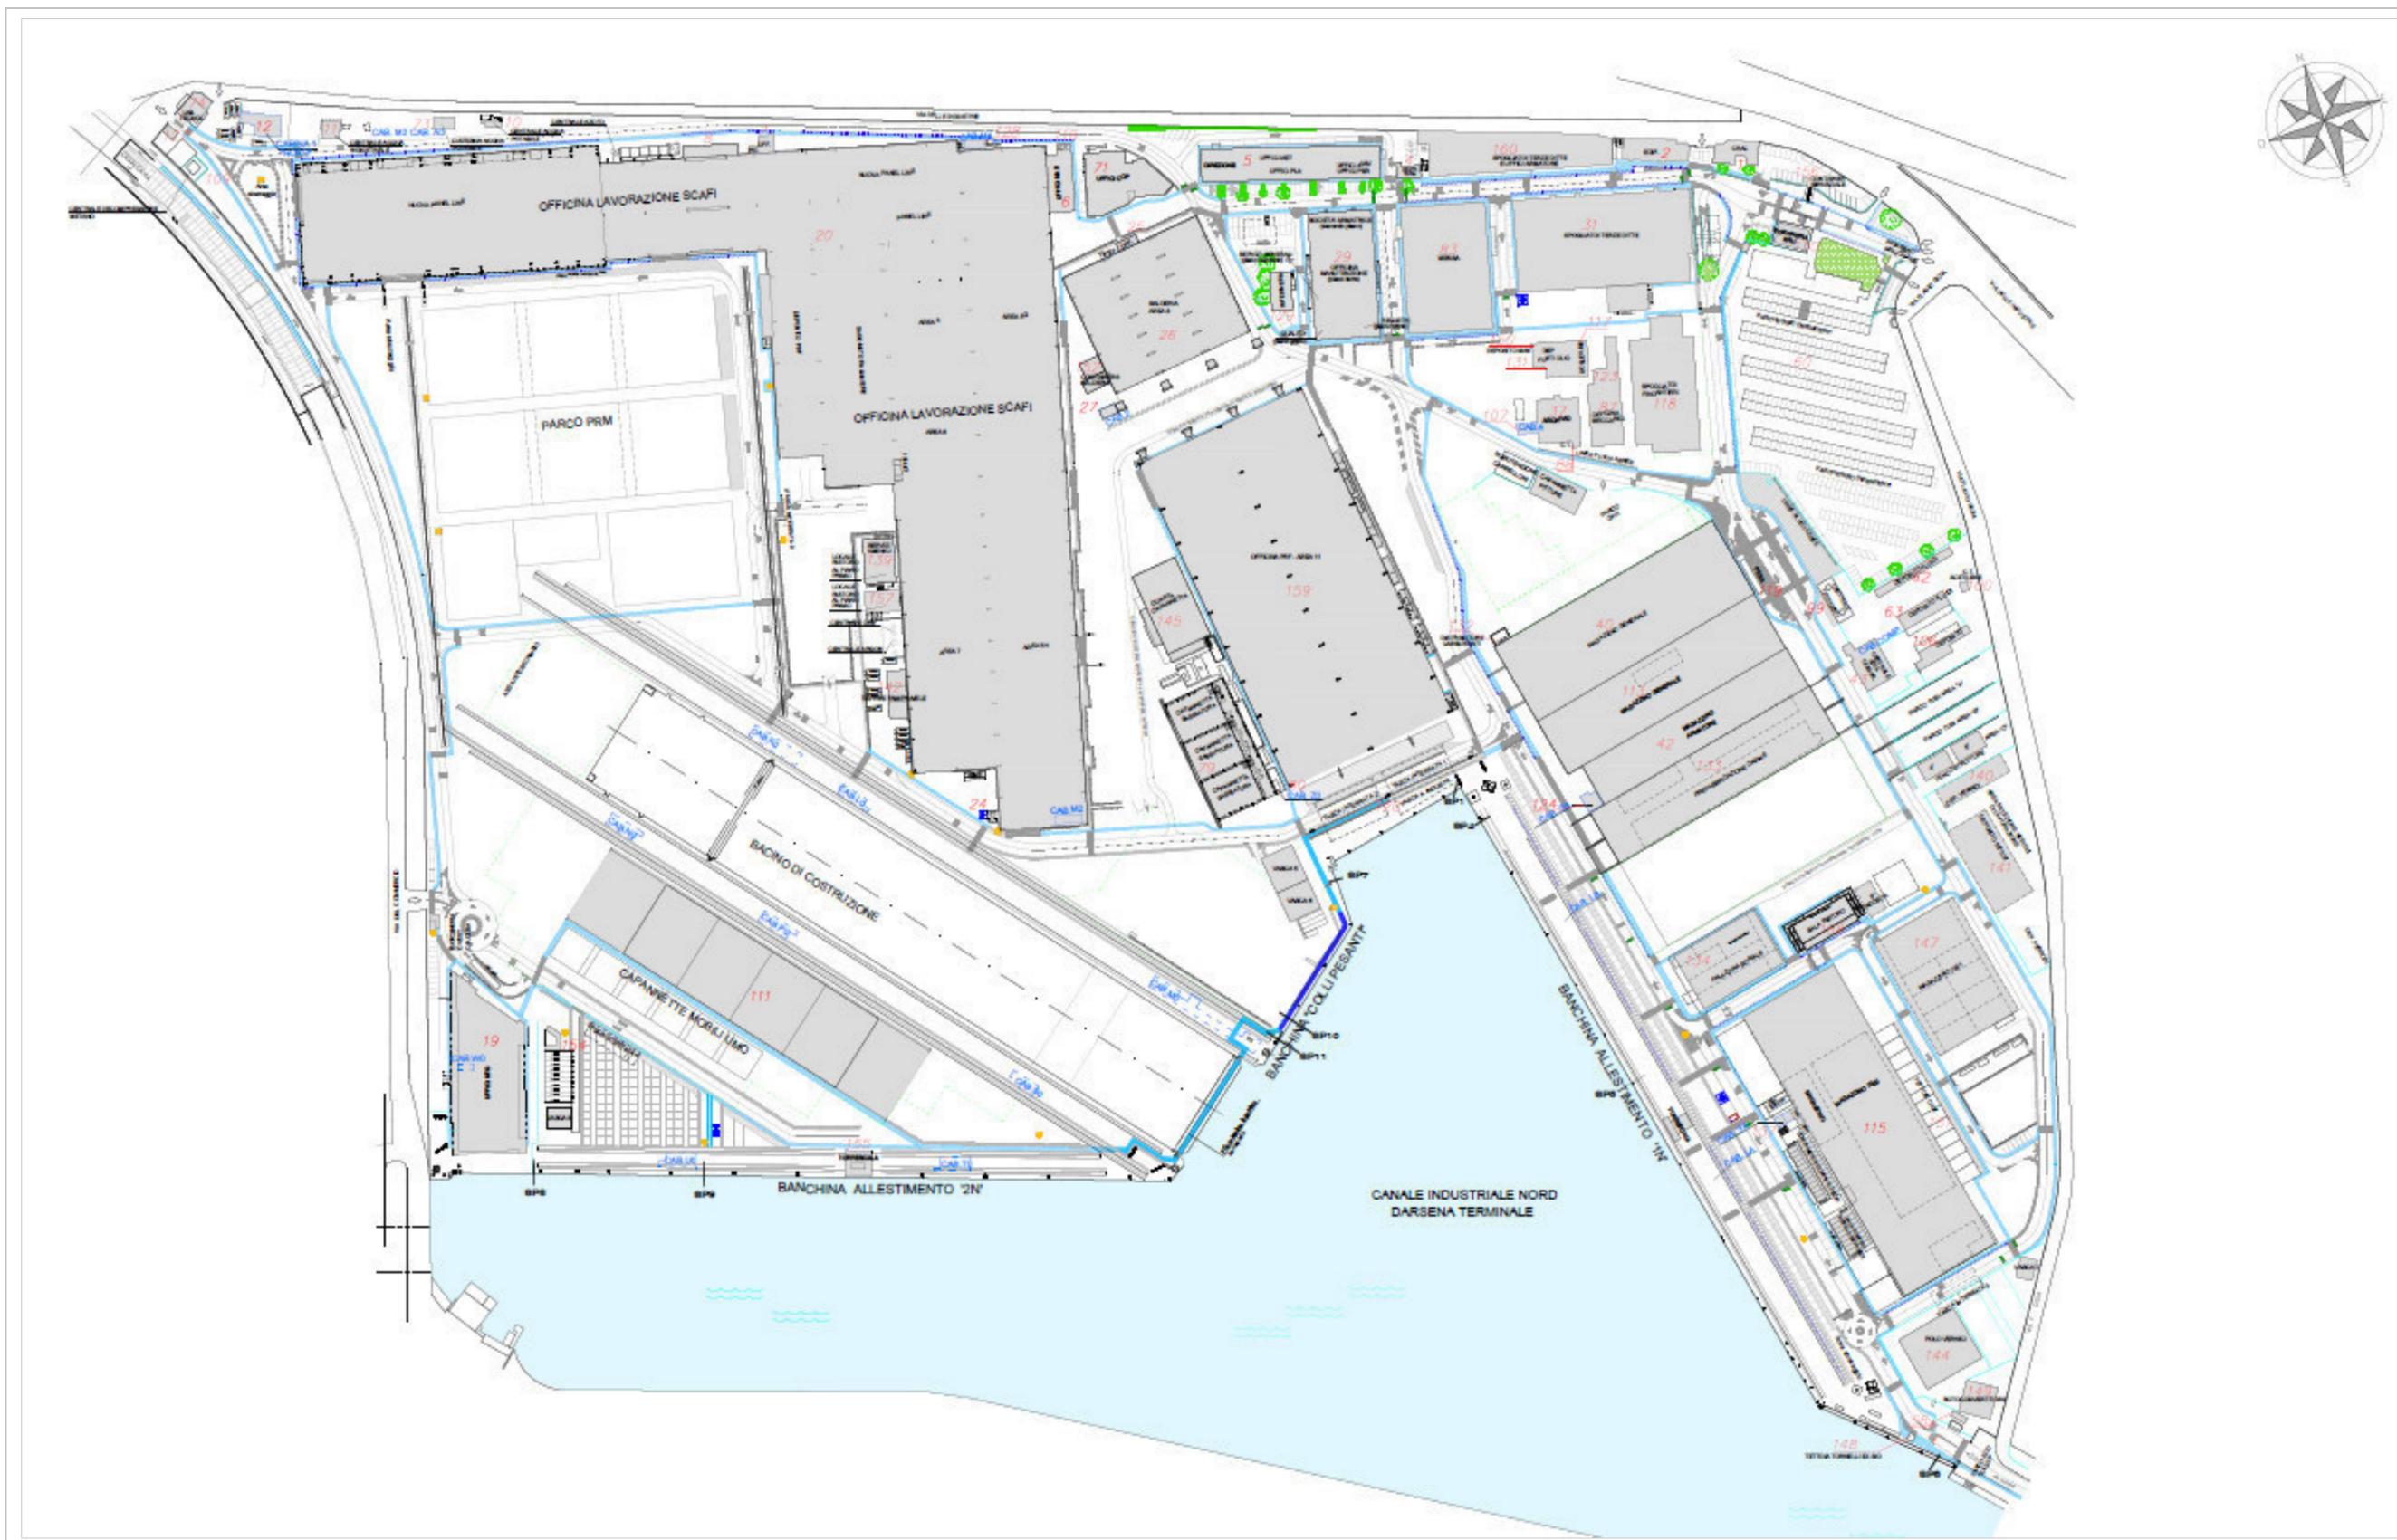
Planimetria Generale dello stabilimento Fincantieri
